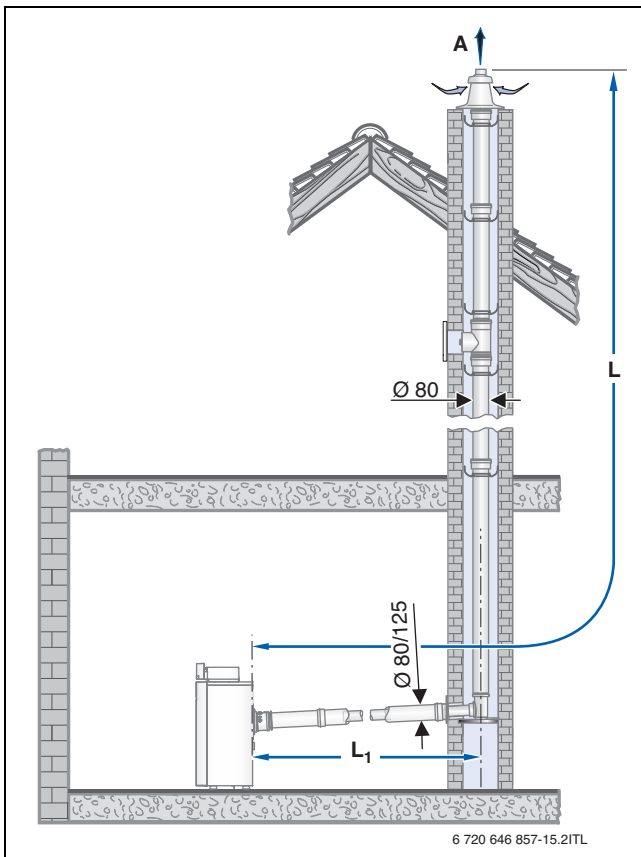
Variantes de montaje con el kit de montaje GA-K
